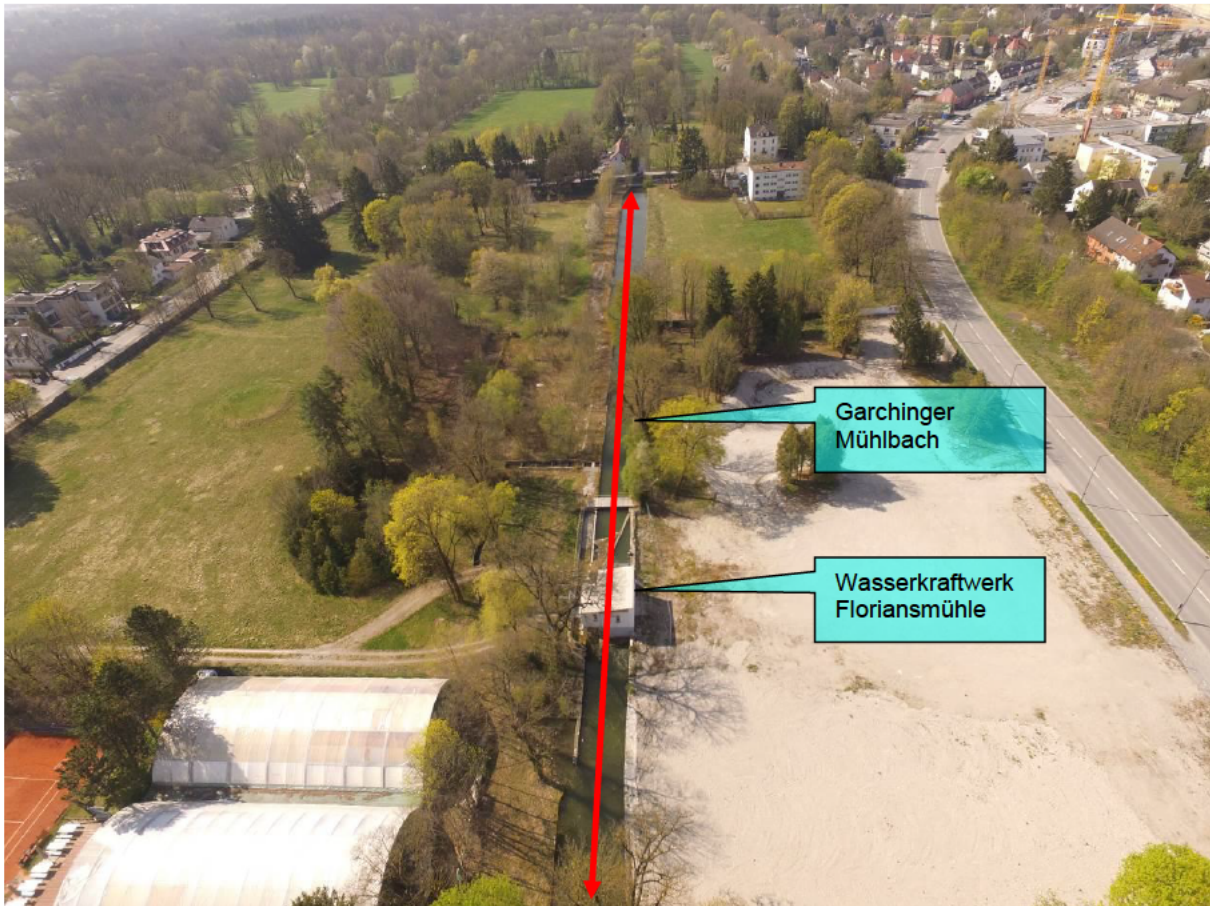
Garchinger Mühlbach und Floriansmühle (Quelle: Bau + Plan)
